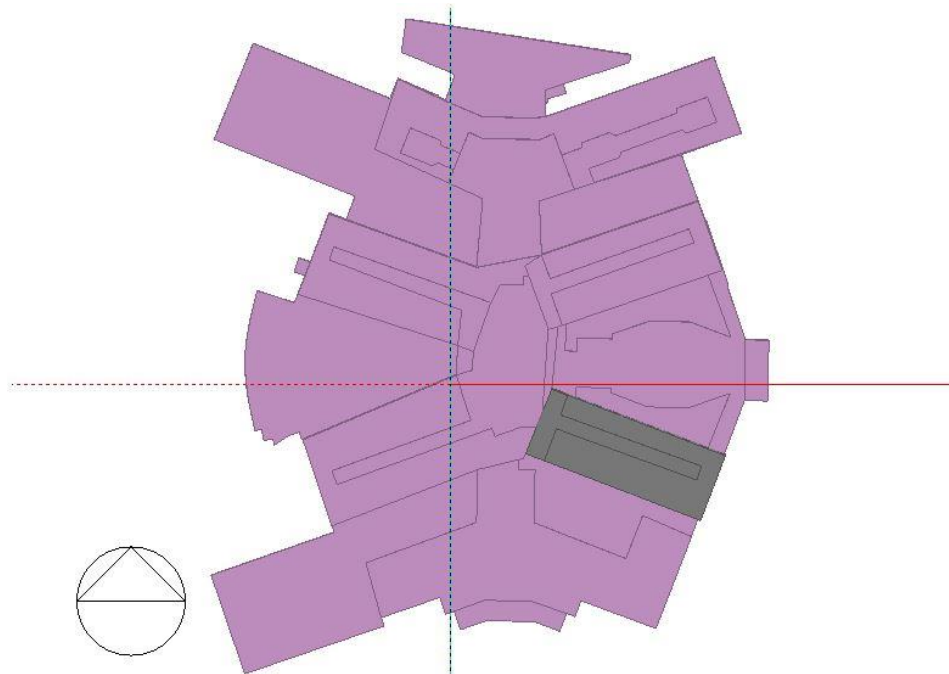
Modelo tridimensional del edificio realizado con Design Builder. Vista en planta con indicación del Norte geográfico. Elaboración propia.
